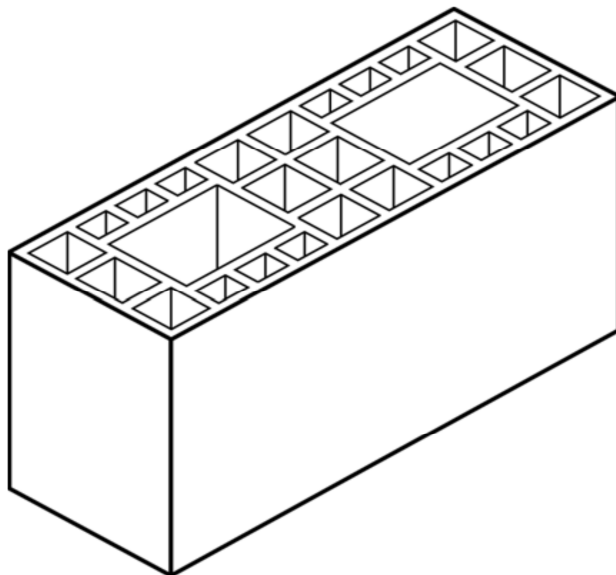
Bloco cerâmico estrutural com paredes vazadas.
